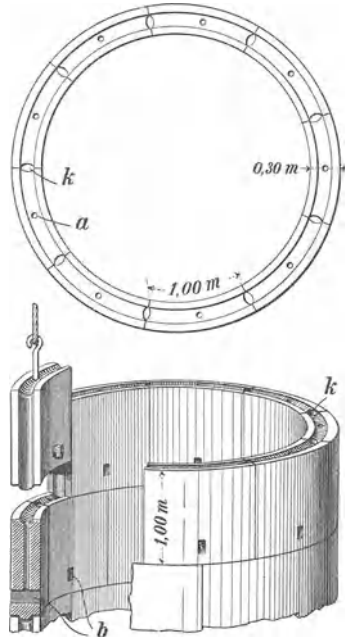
Schachtausbau mit Formsteinen aus Beton.
